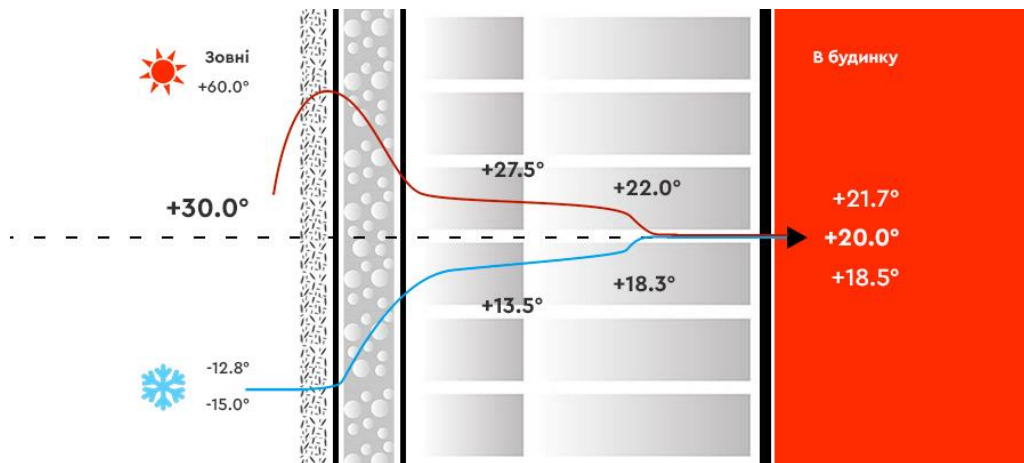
Теплоізоляційний шар фасаду будівельної конструкції
